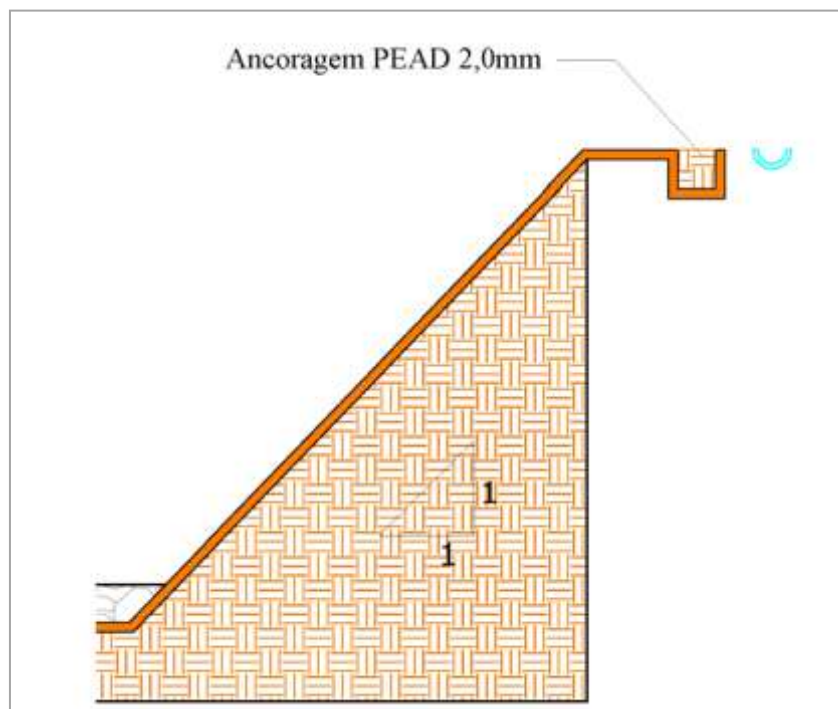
Detalhe do tipo de revestimento e disposição dos equipamentos.
